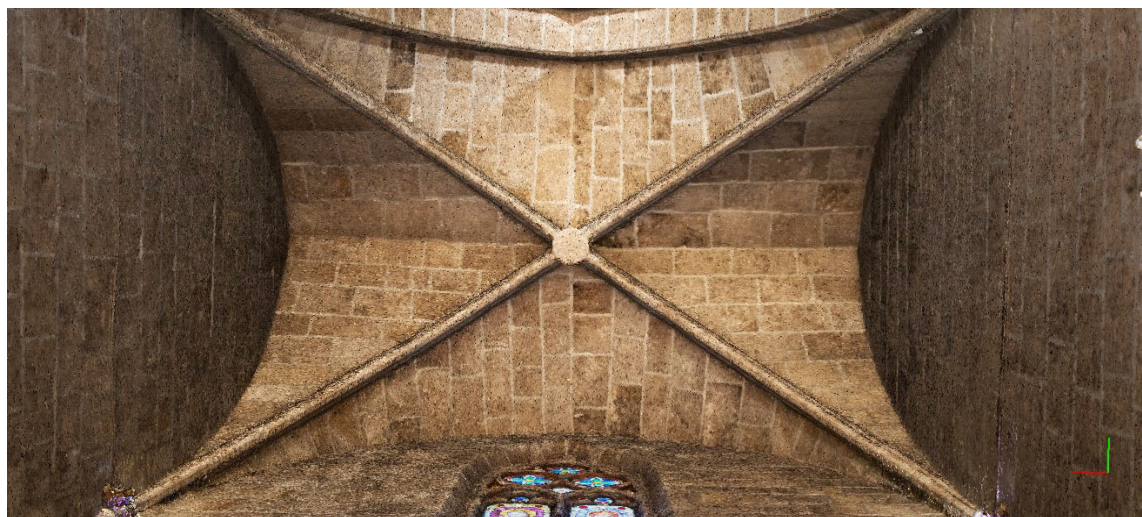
Vistas modelo 3D plementería realizadas con PhotoScan.
